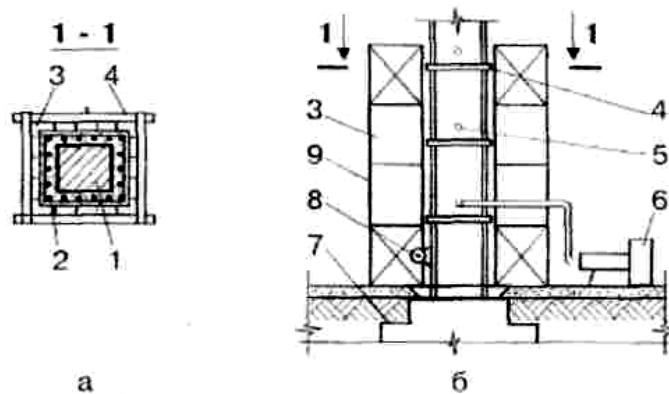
Схема підсилення колони залізобетонною обоймою:
